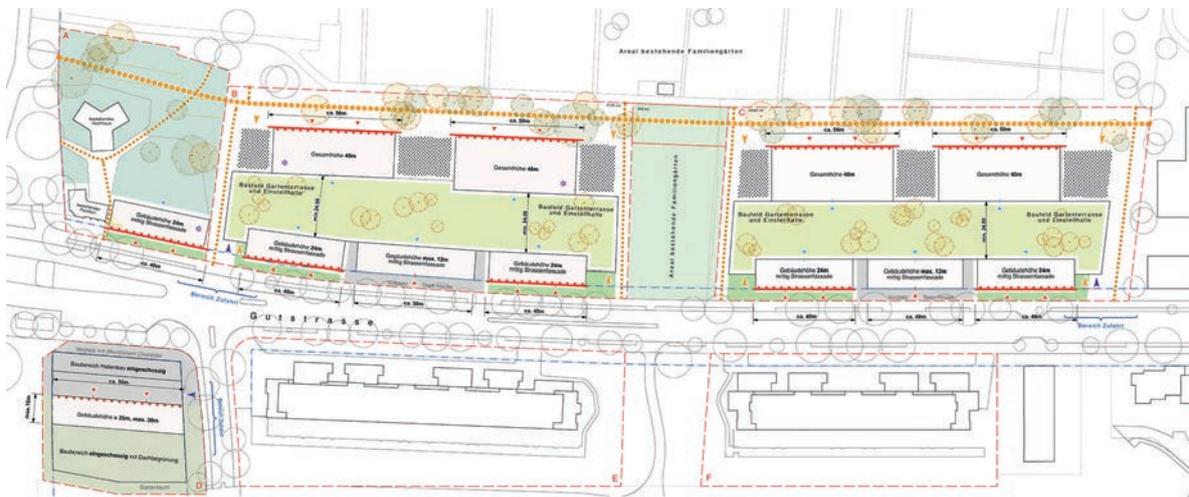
Plan «Masterplan Gutstrasse», Studio Märkli
